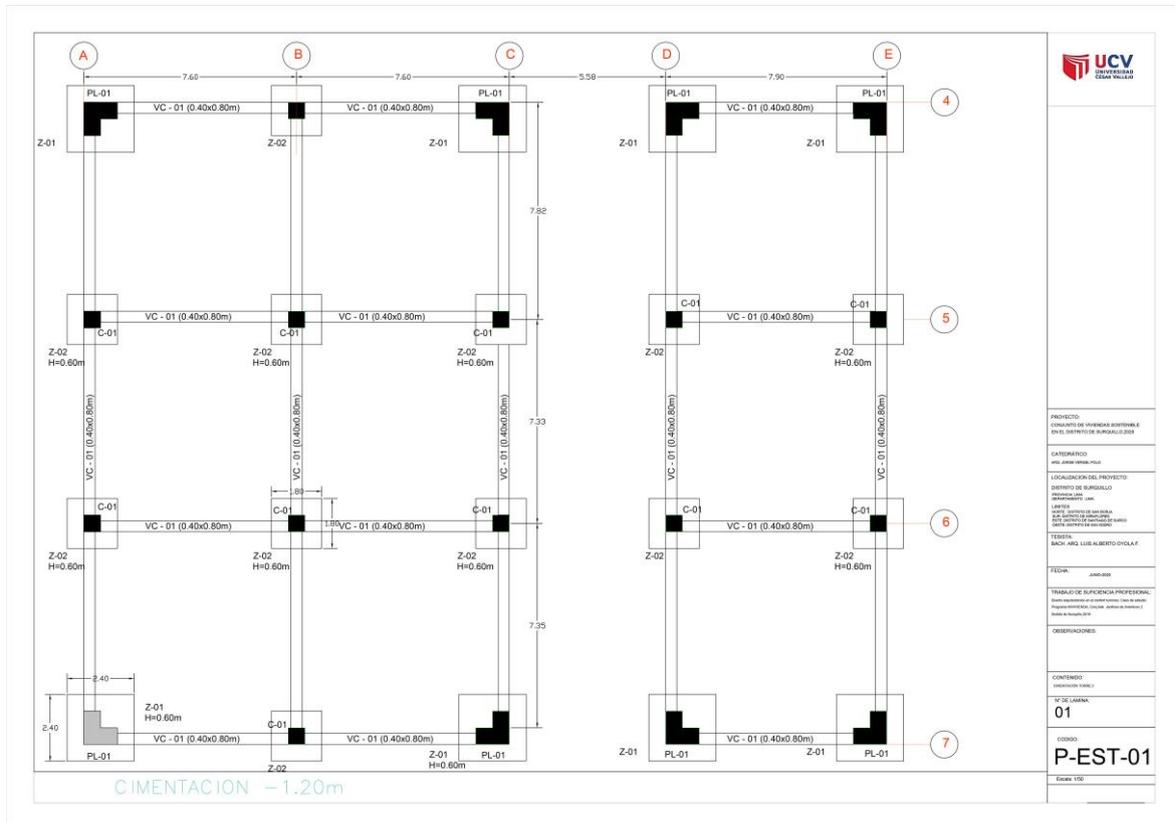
Planos de diseño estructural – a nivel de pre dimensionamiento (sector asignado)
